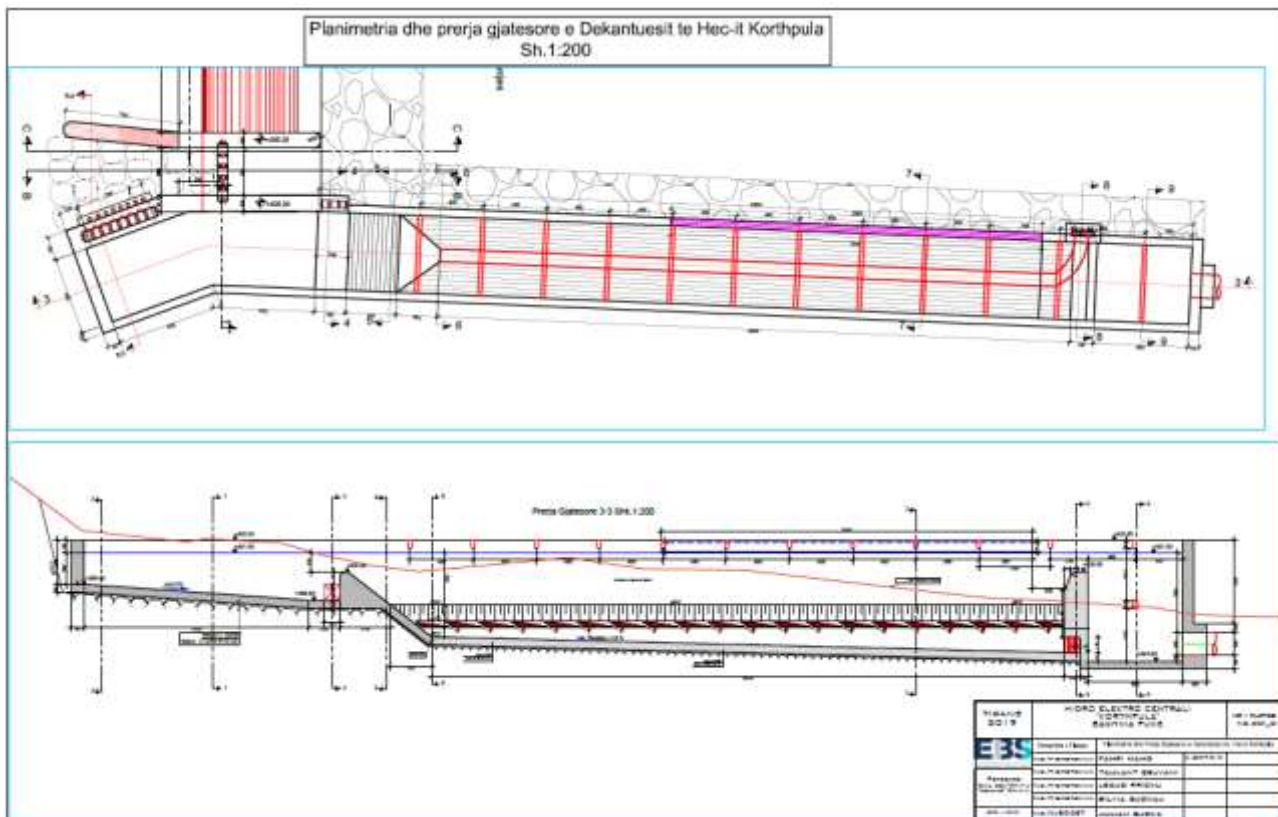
Planimetria dhe prerja gjatesore e dekantuesit
